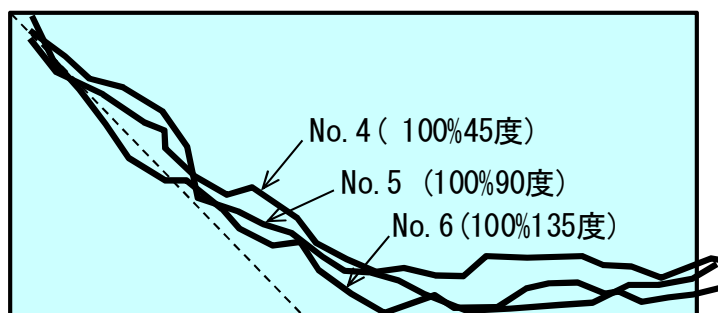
せん断ひび割れ位置 (試験番号 4～6)
